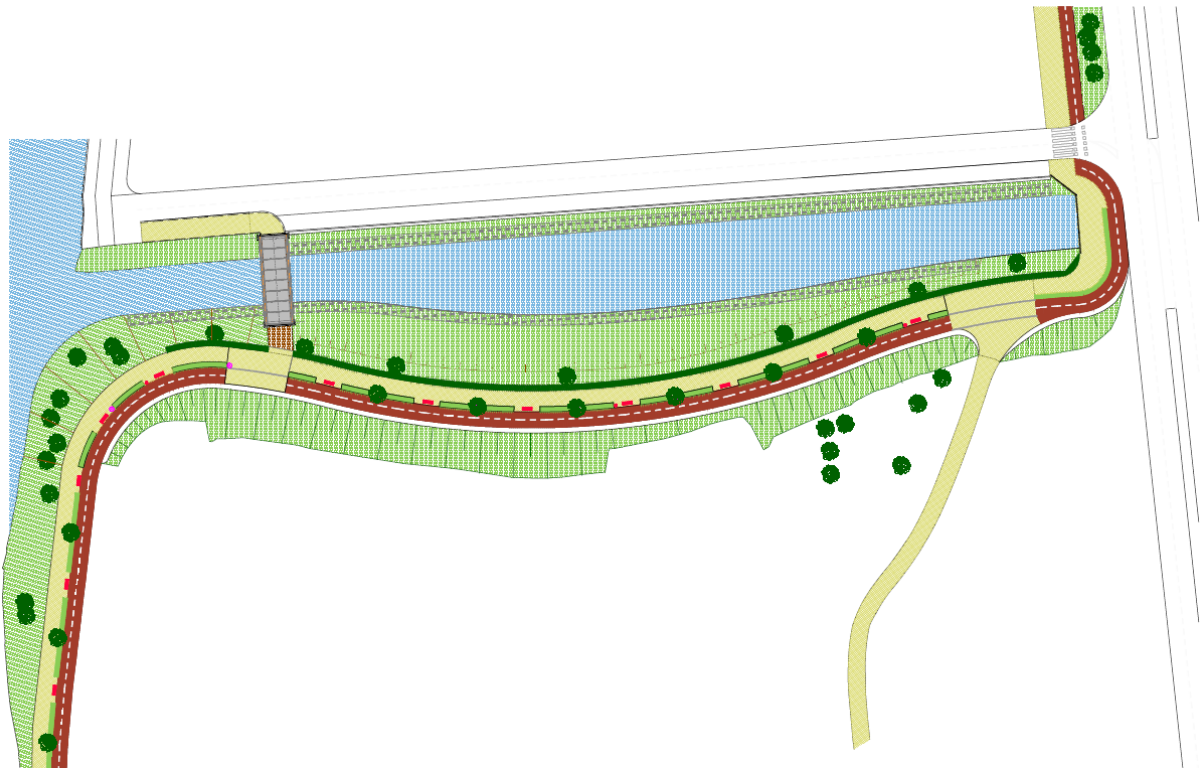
Planta propuesta. Fuente: Borrador del Proyecto.
